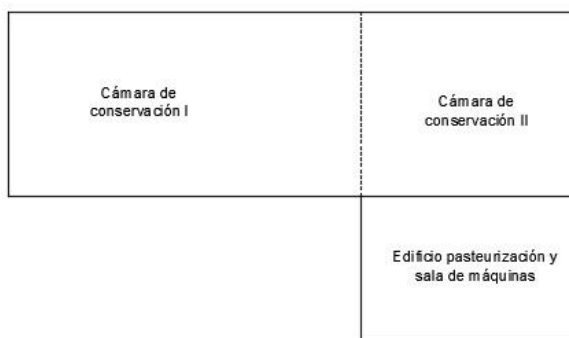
Distribución en planta nave industrial. (Fuente: Creación Propia)
